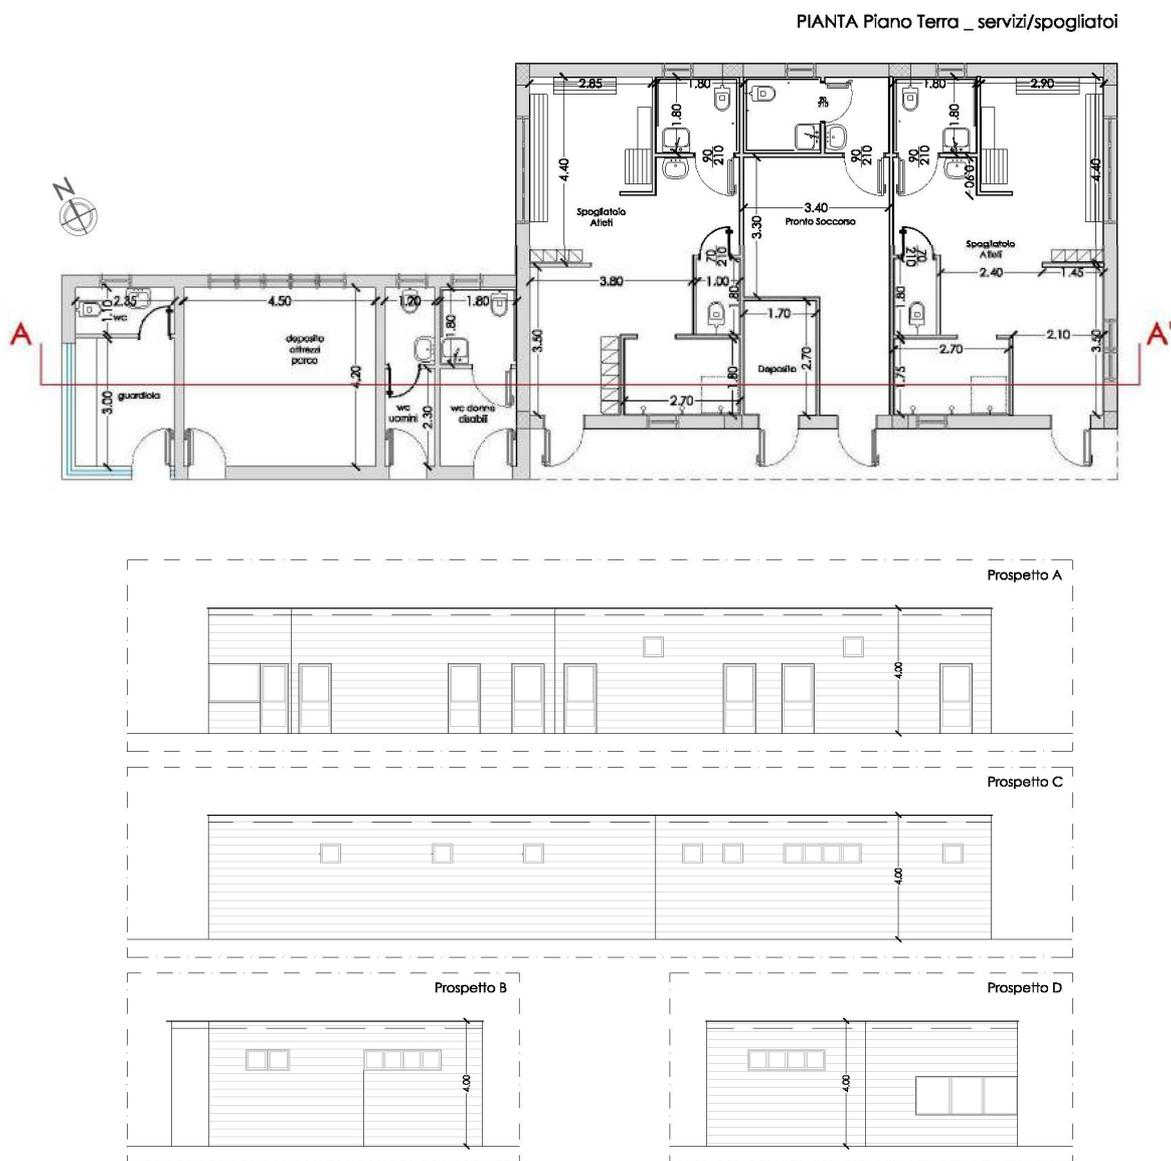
schema di progetto blocco spogliatoi-servizi \_ Pianta e Prospetti
